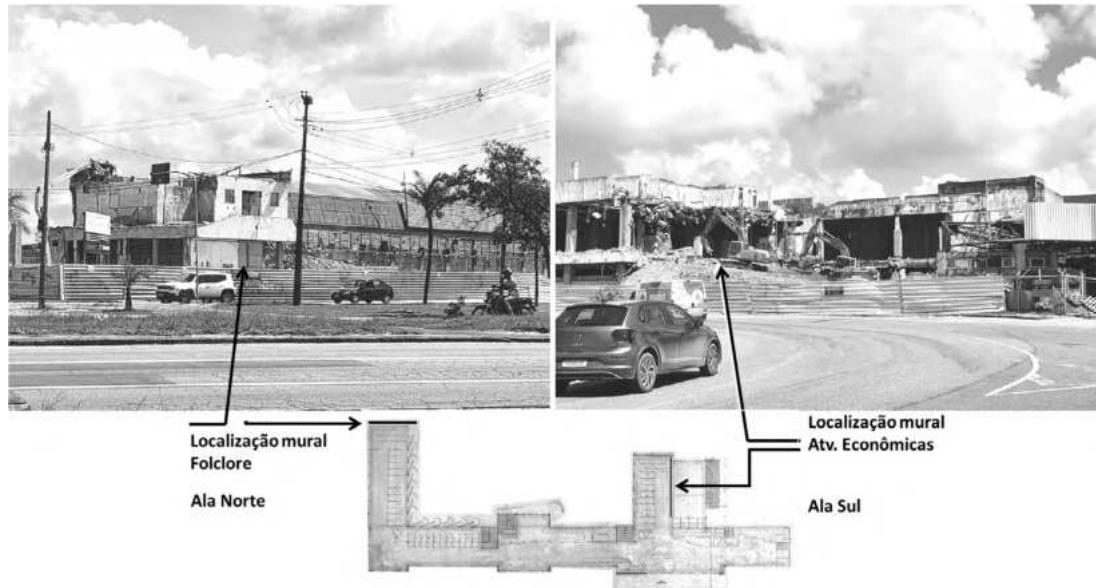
Demolição do antigo terminal em andamento (27 jun. 2024), com as localizações dos murais na planta do projeto de nov. 1949 e na atualidade. FONTE: autores.
